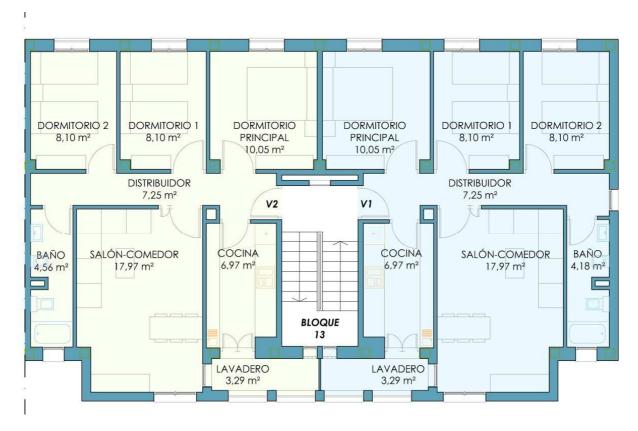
Plano Planta Primera y Segunda; bloque 13.17
